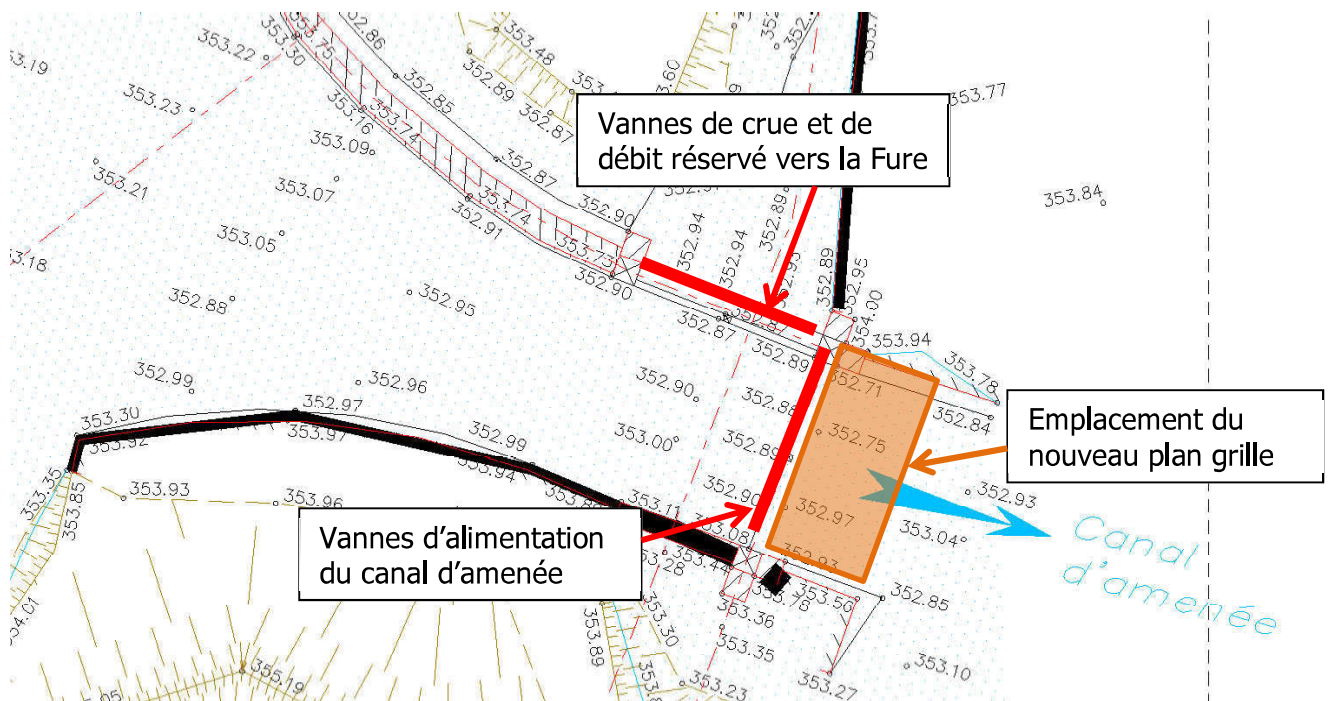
IMPLANTATION DU NOUVEAU PLAN GRILLE AU DROIT DU SEUIL DE PRISE D'EAU DE GRANDE CHUTE
